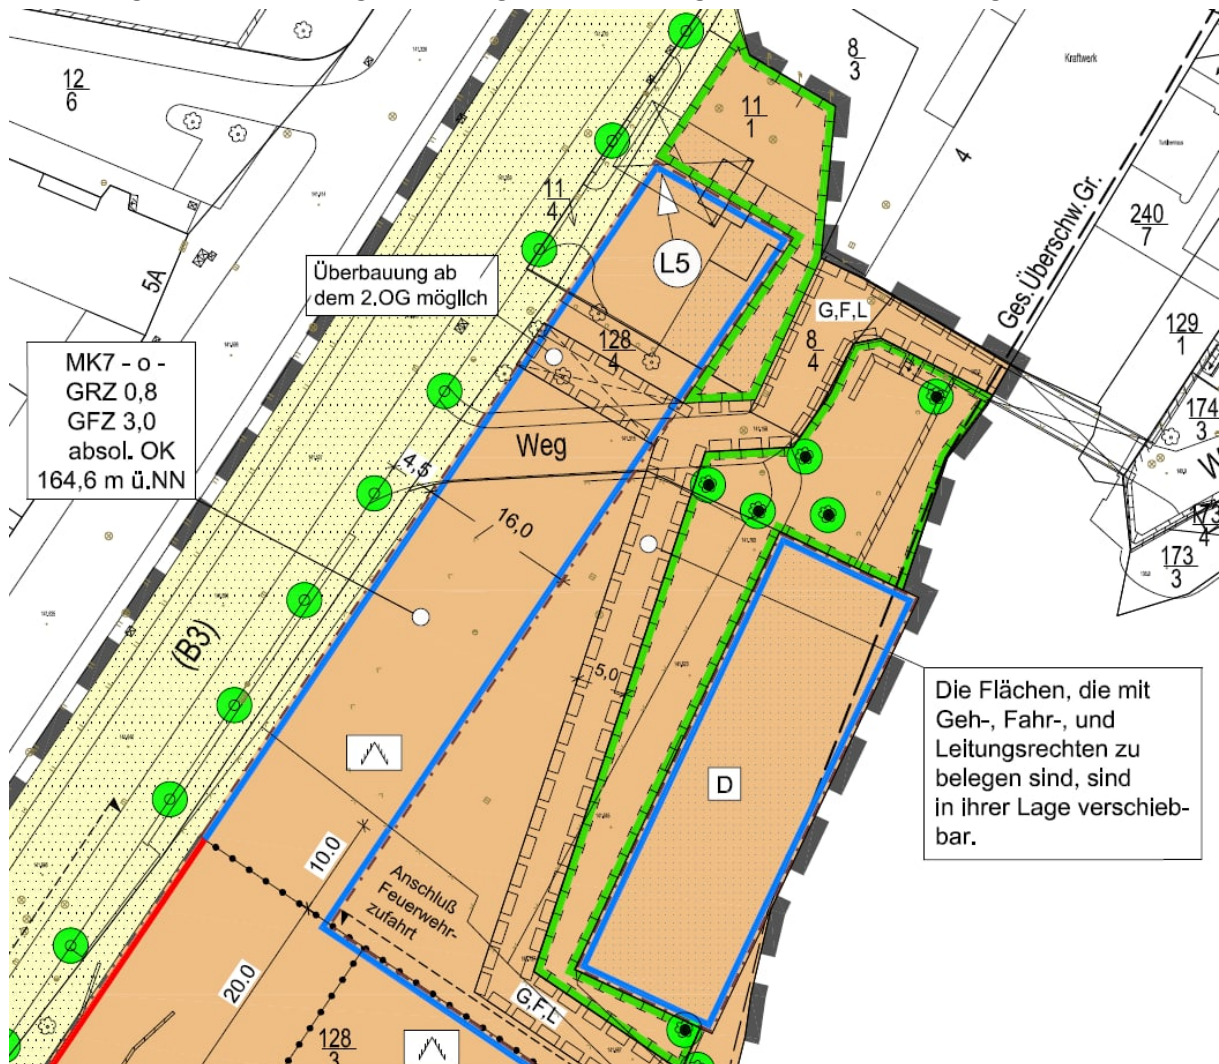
Planausschnitt zeichnerische Darstellung des Entwurfes des Bebauungsplans Nr. I/10
